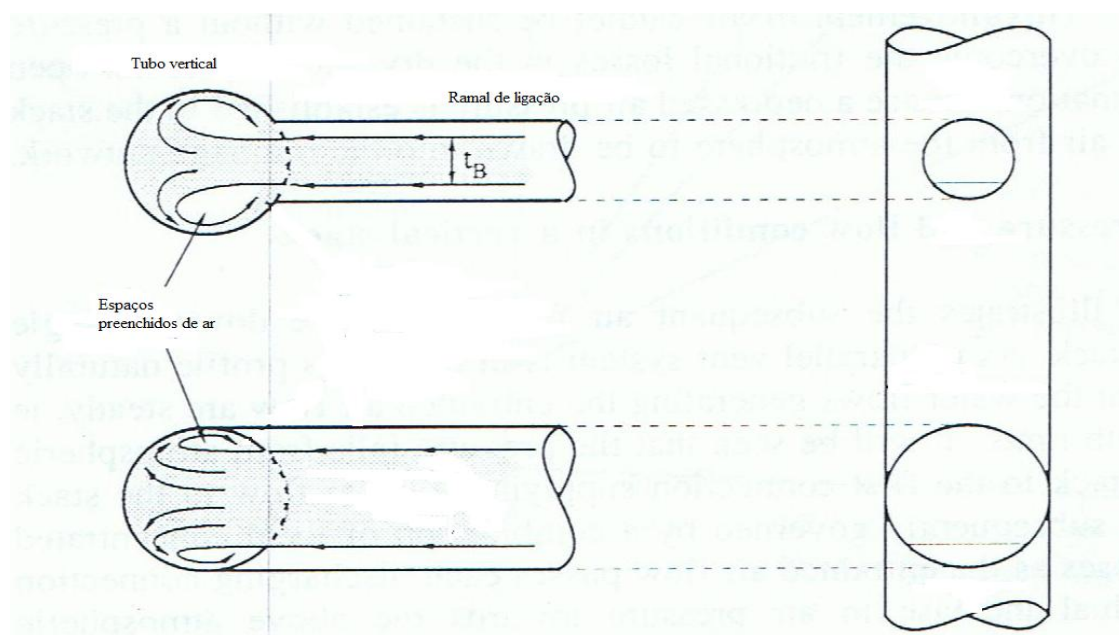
Descarga do escoamento no tubo de queda, vista em corte e em planta.
